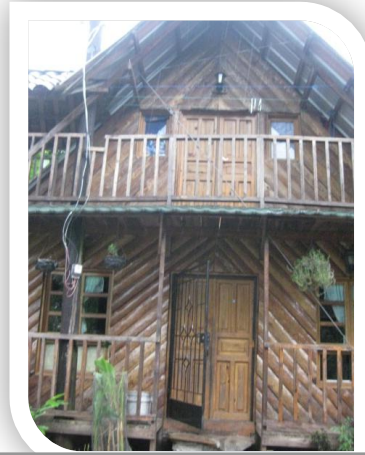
vivienda construida con materiales del lugar de dos niveles
